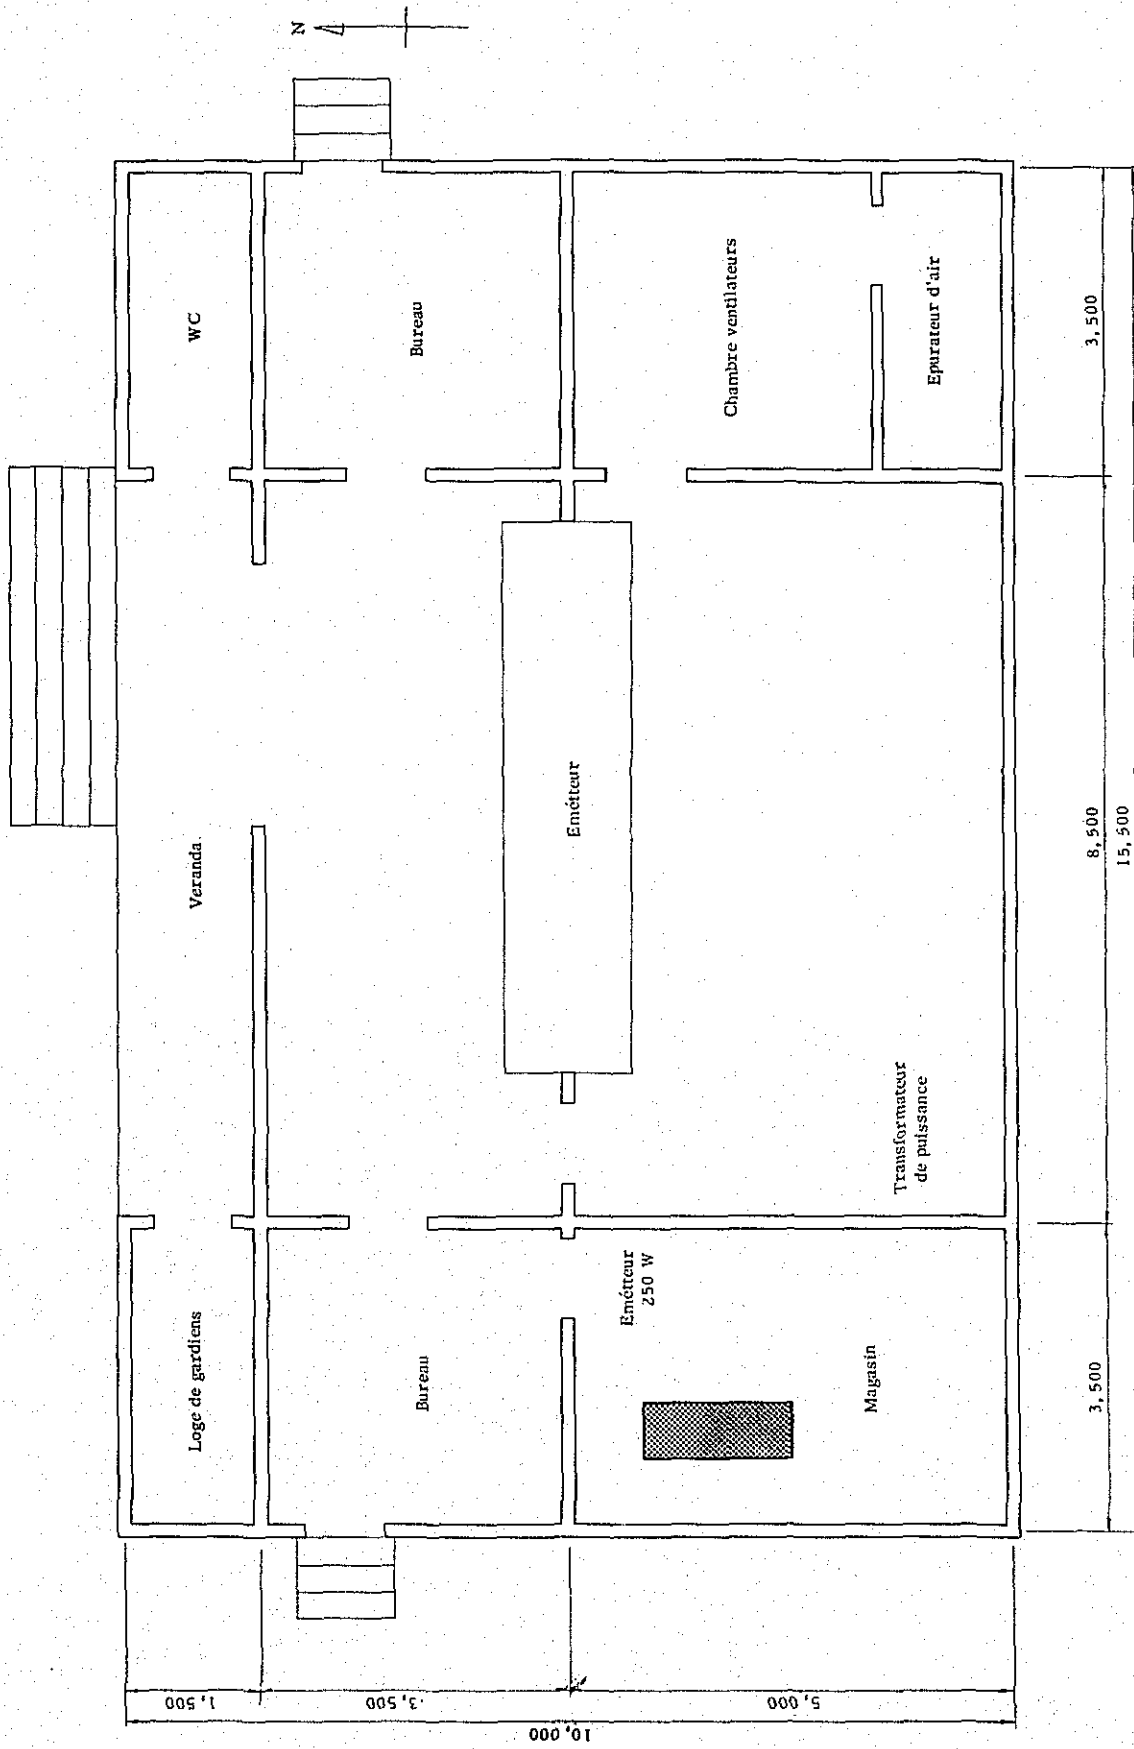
PLAN D'UNE STATION D'EMISSION DE TV
